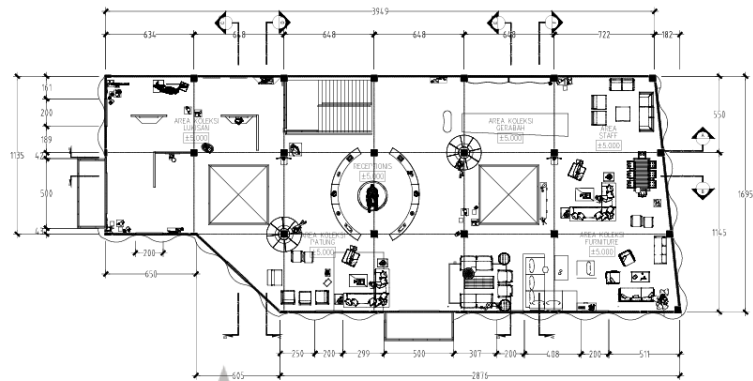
Layout Lantai 01 Alternatif 01 (Terpilih)
